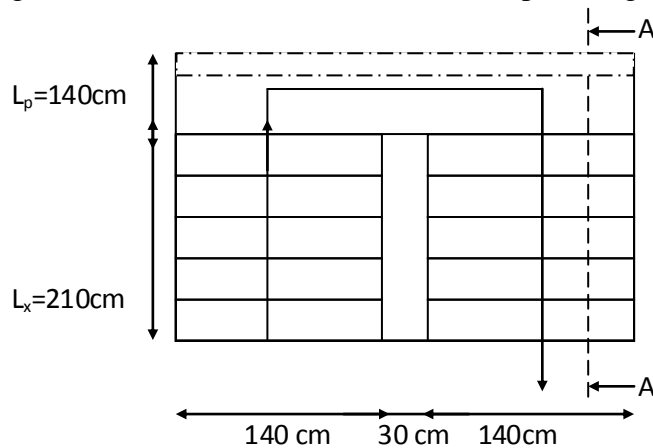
Vue en plan du 1^{er} type d'escalier
